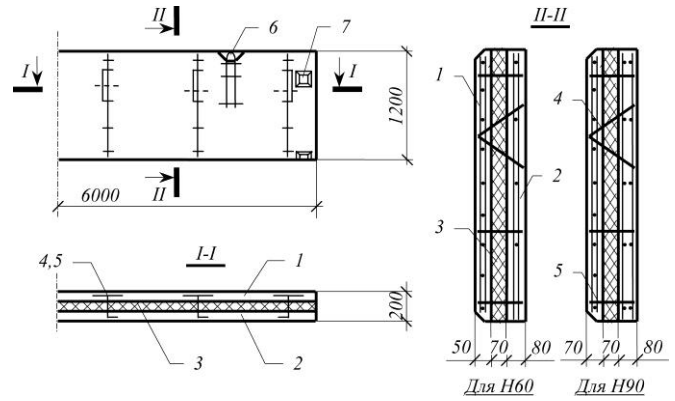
Опалубка та армування дослідних моделей, розрахованих на горизонтальні навантаження 60 (Н-60) і 90 (Н-90) кгс/м²: 1; 2 – зовнішній і внутрішній залізобетонні шари відповідно; 3 – ефективний утеплювач (мінераловатні плити, ФРП-1 та ін.); 4 – підвіска; 5 – розпірка; 6 – монтажна петля; 7 – закладна деталь.
